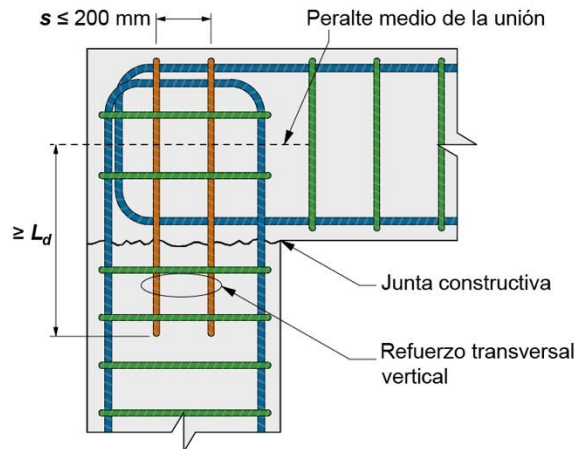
a – Refuerzo transversal horizontal y vertical en uniones de rodilla (adaptada de ACI CODE-318-19)
